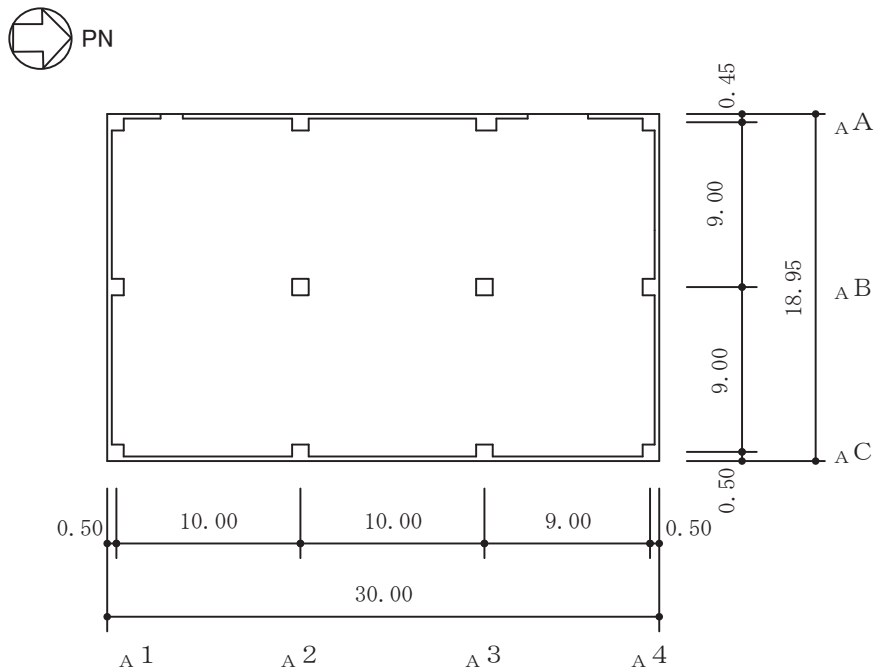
(1) 補助ボイラー建屋の概略平面図 (O.P.\*11.0m)
